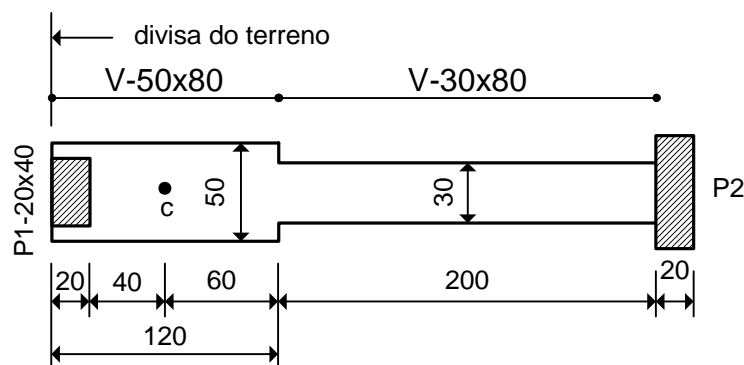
Viga de equilíbrio para pilar de divisa
